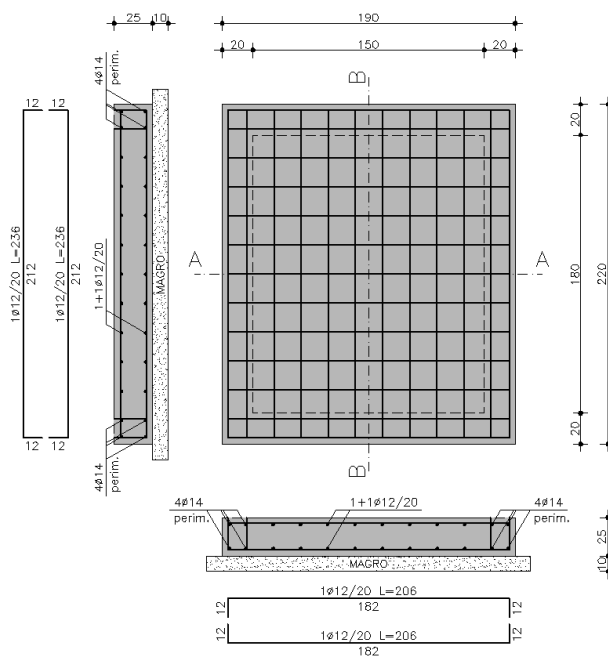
Pozzetto n. 7 - Sezione sul fondo
